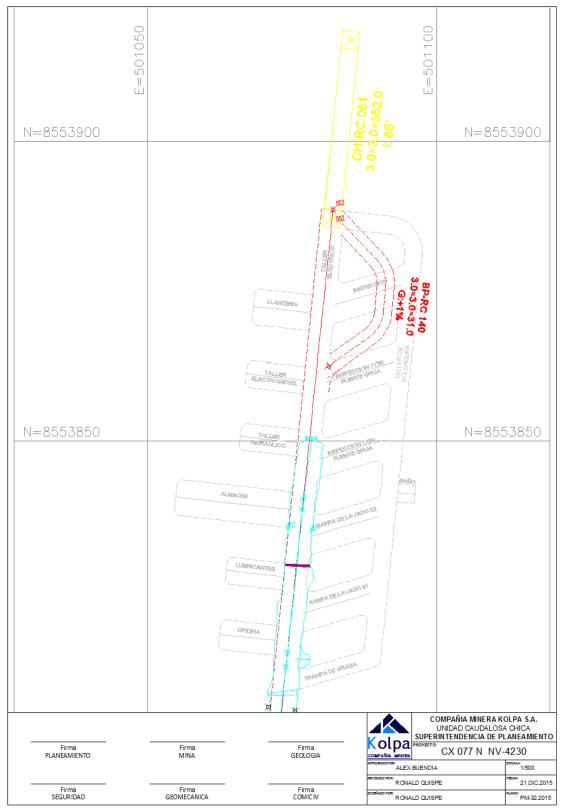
Vista en planta de la chimenea alimak 081
